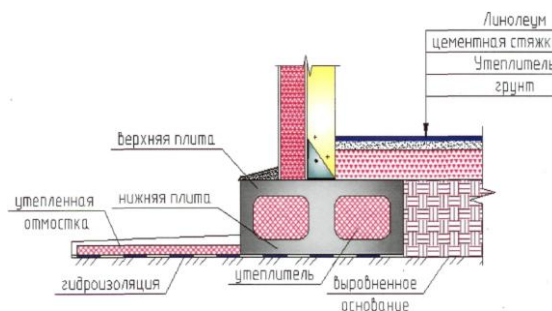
Ленточный плитно-рамный фундамент. Поперечное сечение
